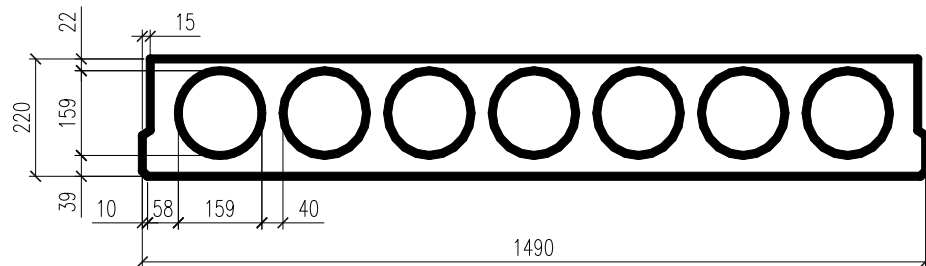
Поперечний переріз багатопустотної плити
